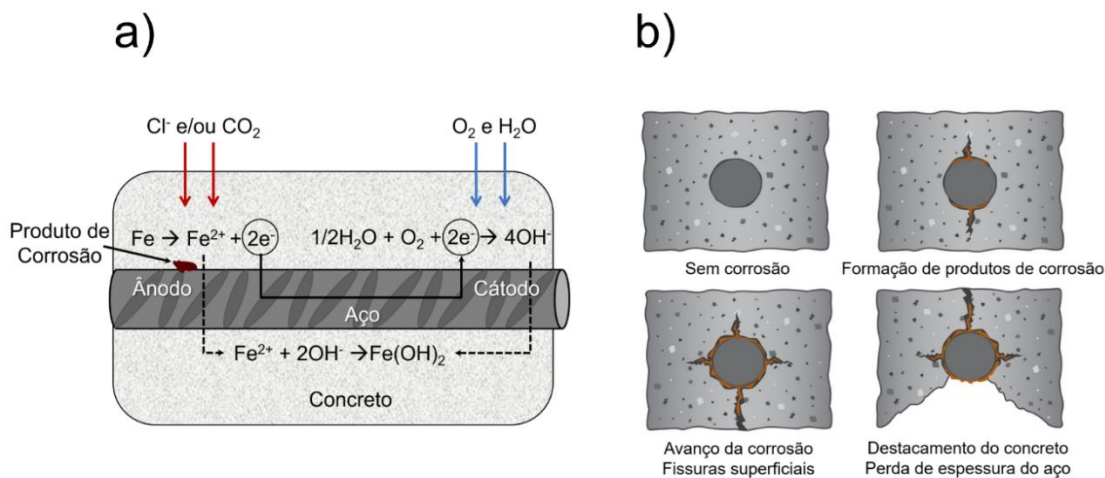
a) Ilustração da corrosão eletroquímica em concreto armado (modificado de [9]) e b) o impacto da corrosão na degradação das armaduras em aço e na cobertura de concreto [10].
